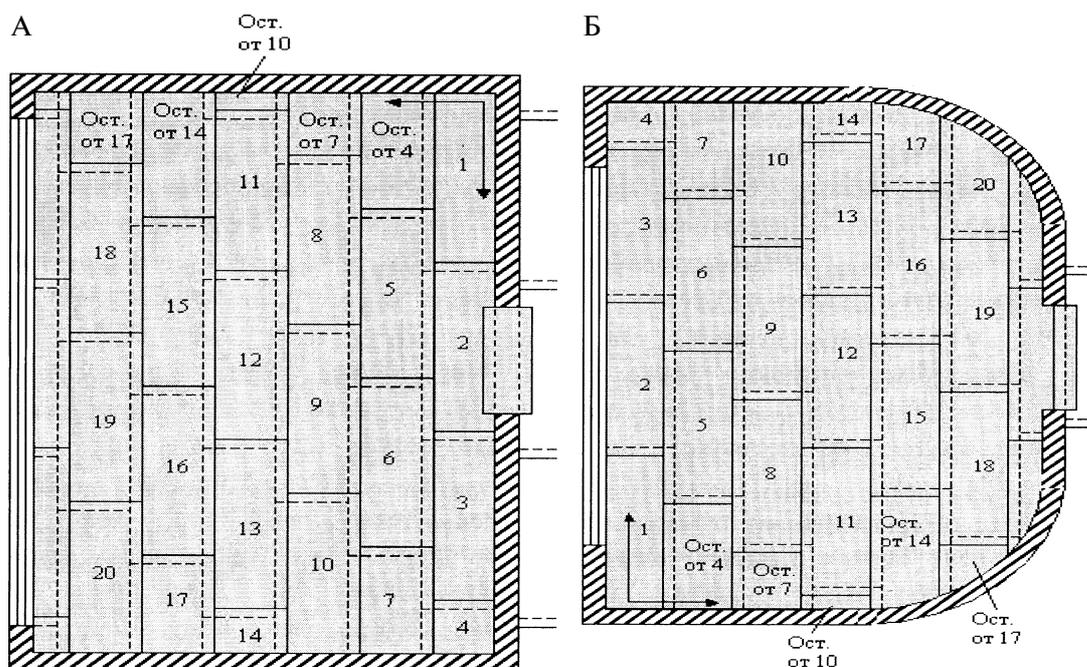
Схема раскладки сборной стяжки из гипсоволокнистых плит на слой тепло- звукоизоляции из керамзитового песка (А) и пенополистирольных плит (Б)
